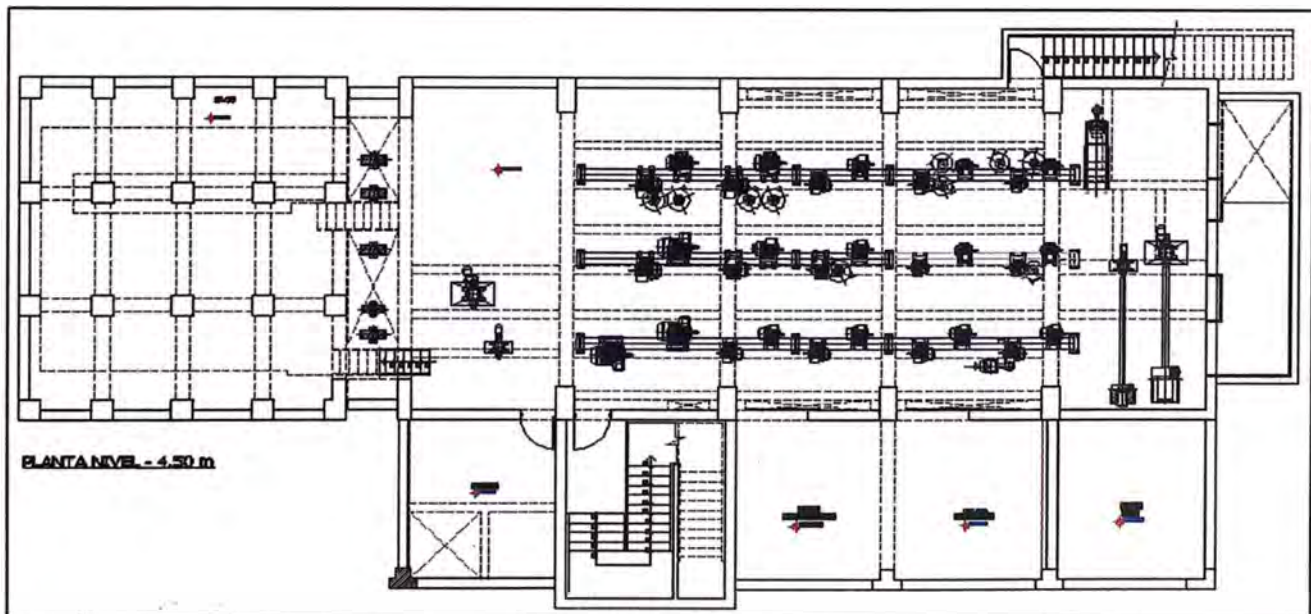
VISTA DE PLANTA TÍPICA DE LA EDIFICACIÓN
